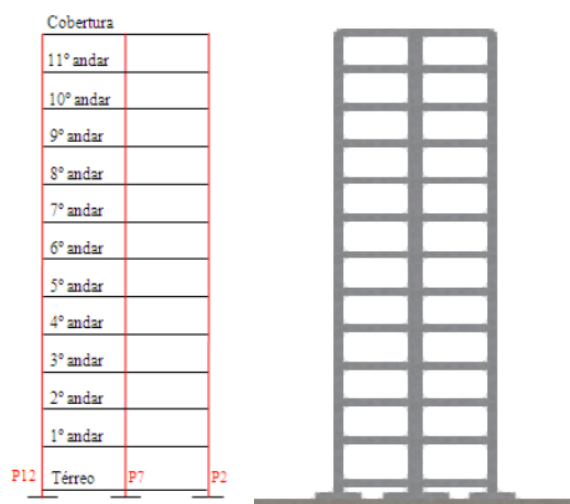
Elevação lateral do edifício. (a) Objeto de estudo em Antoniazzi (2011); (b) Elemento modelado pelo RFEM.
